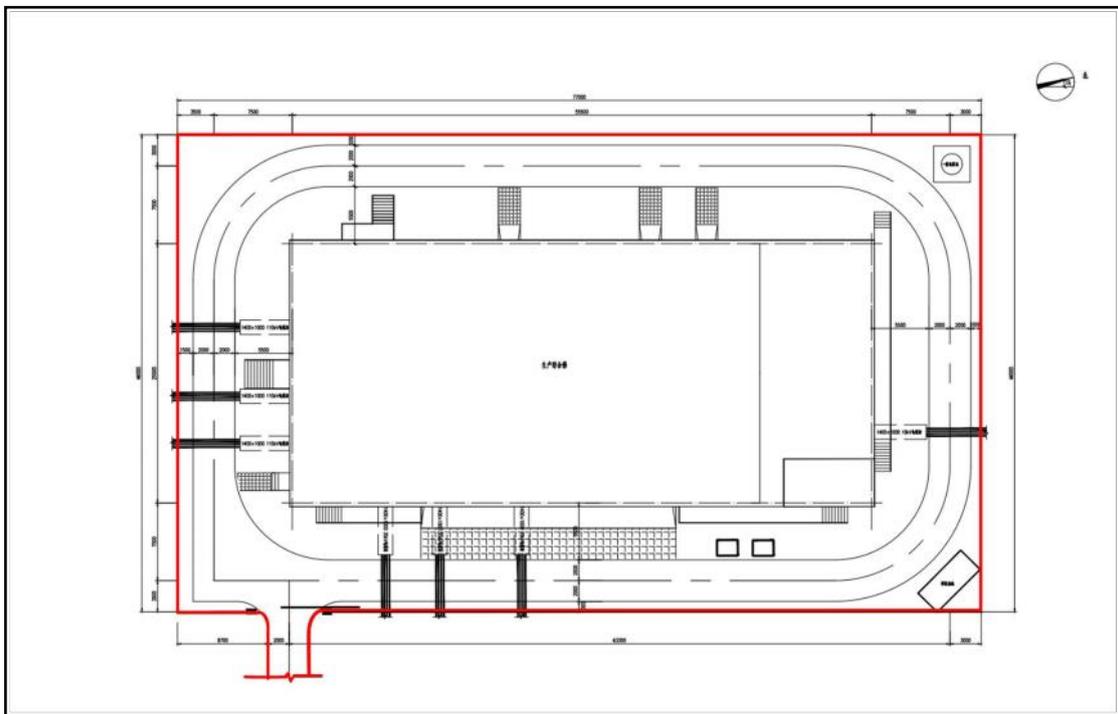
新村沙 35 千伏变电站新建工程总平面布置图
